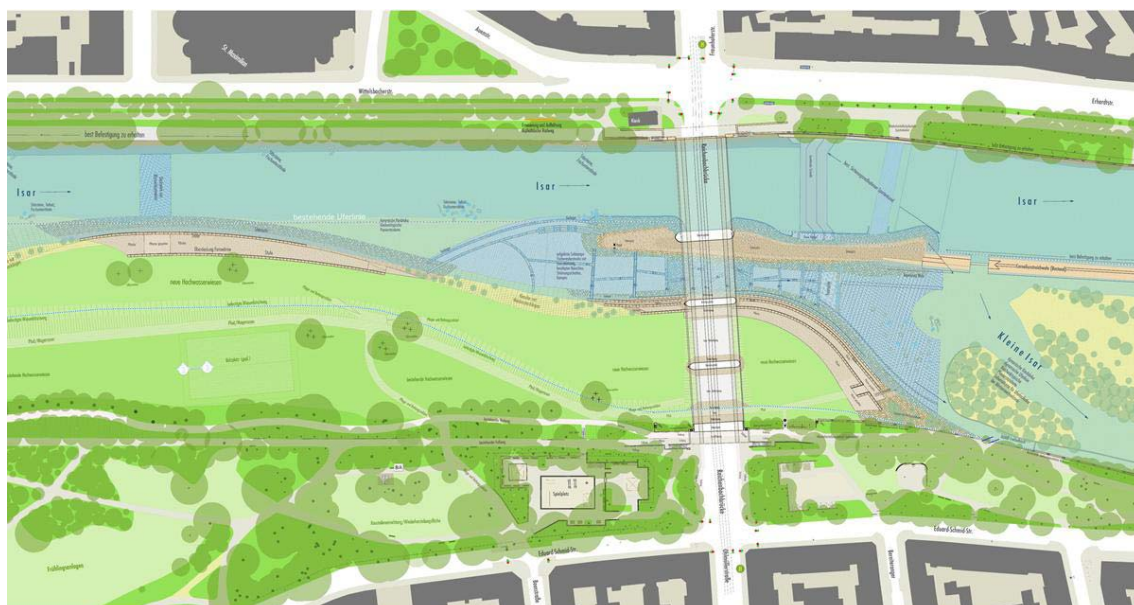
Detalle. Planta proyecto final «Isarplan BA5». Burkhardt
